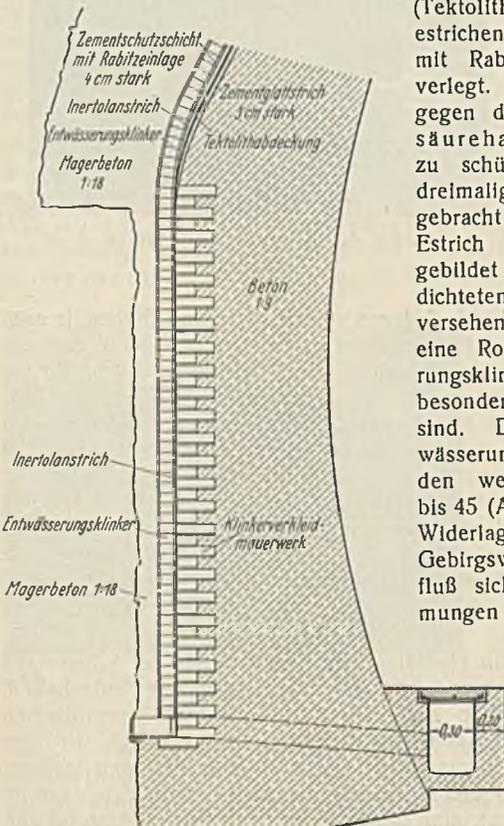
Entwässerung und Abdichtung in den Zonen 1 bis 45.
